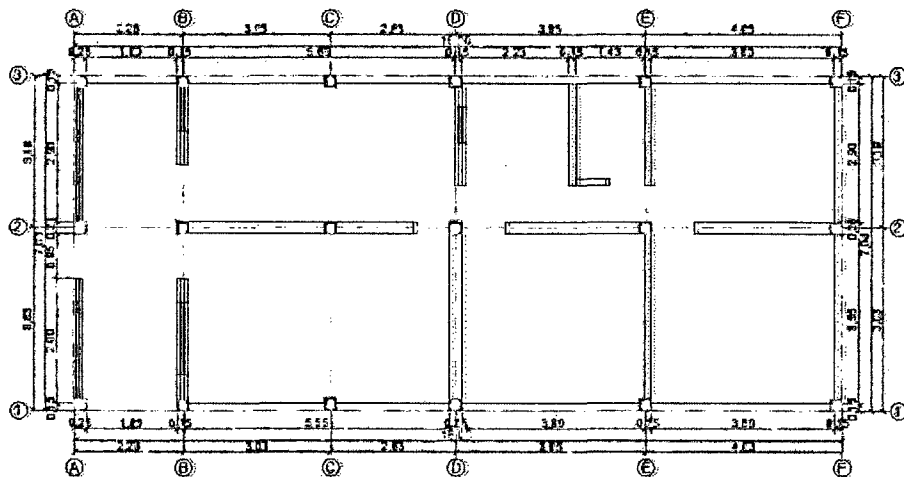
Plano de arquitectura de la planta típica de la Vivienda TV9.
